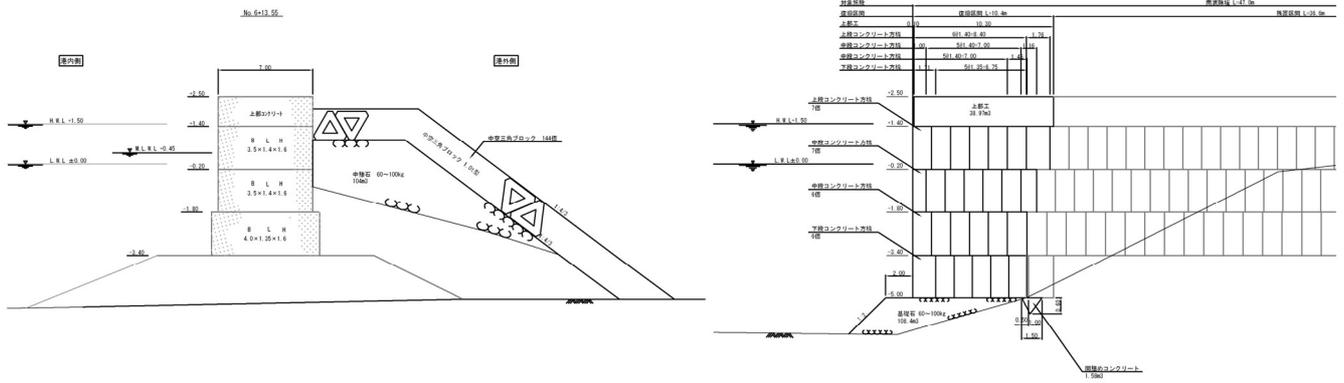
No.6 大洗港区_南波除堤の断面図 (復旧後)
